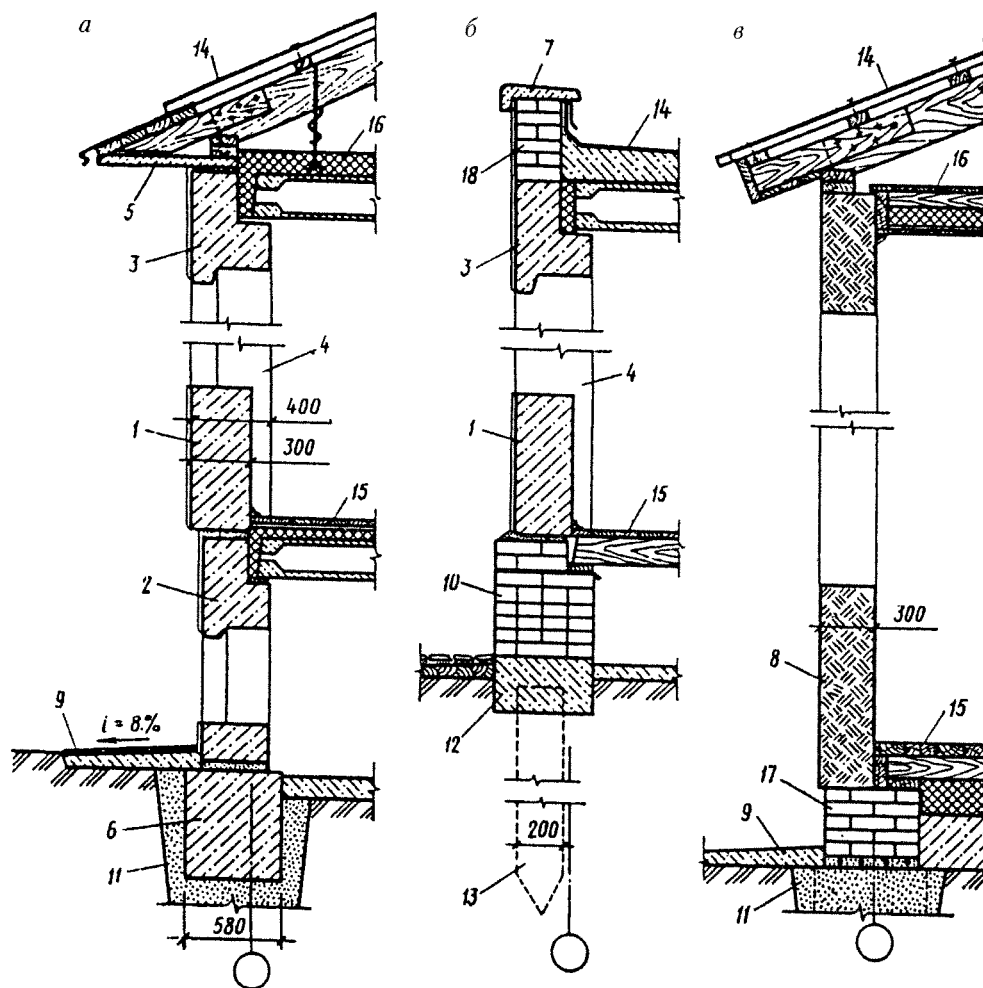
Варианты решения наружных стен из крупных блоков:
